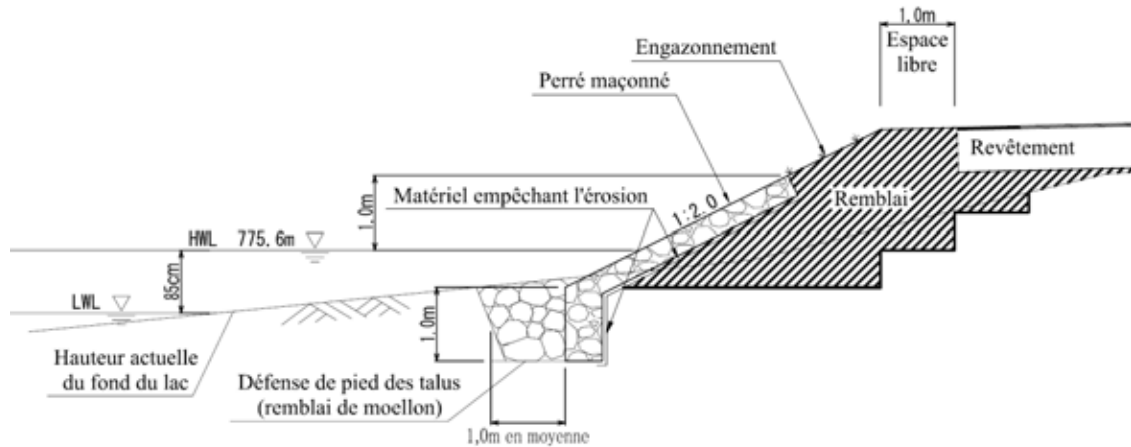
Section standard de revêtement de berges de la route côtière le long du Lac
